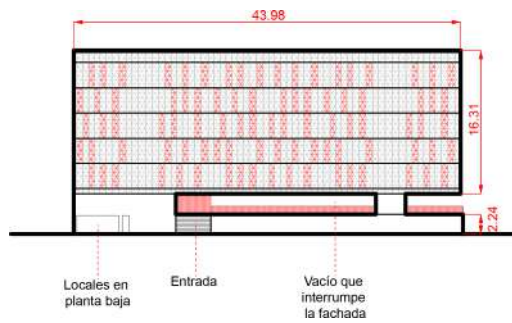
Alzado de Carabanchel 20 en la calle Valle del Boi
